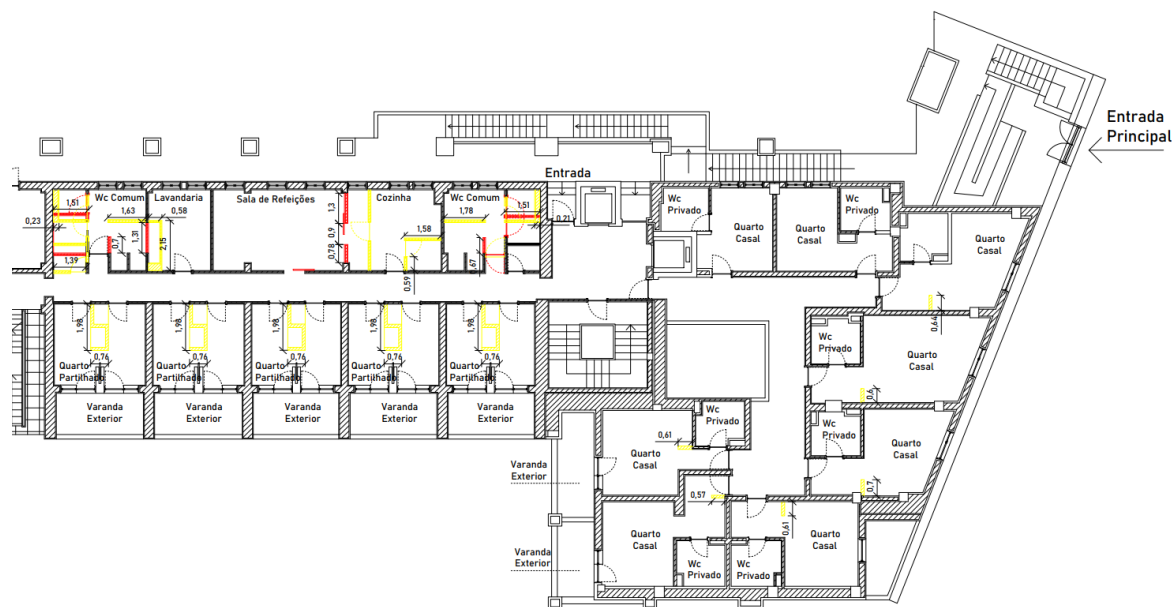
Planta de demolição e construção do piso 0, (planta não representada no seu total para uma melhor compreensão de projeto)
